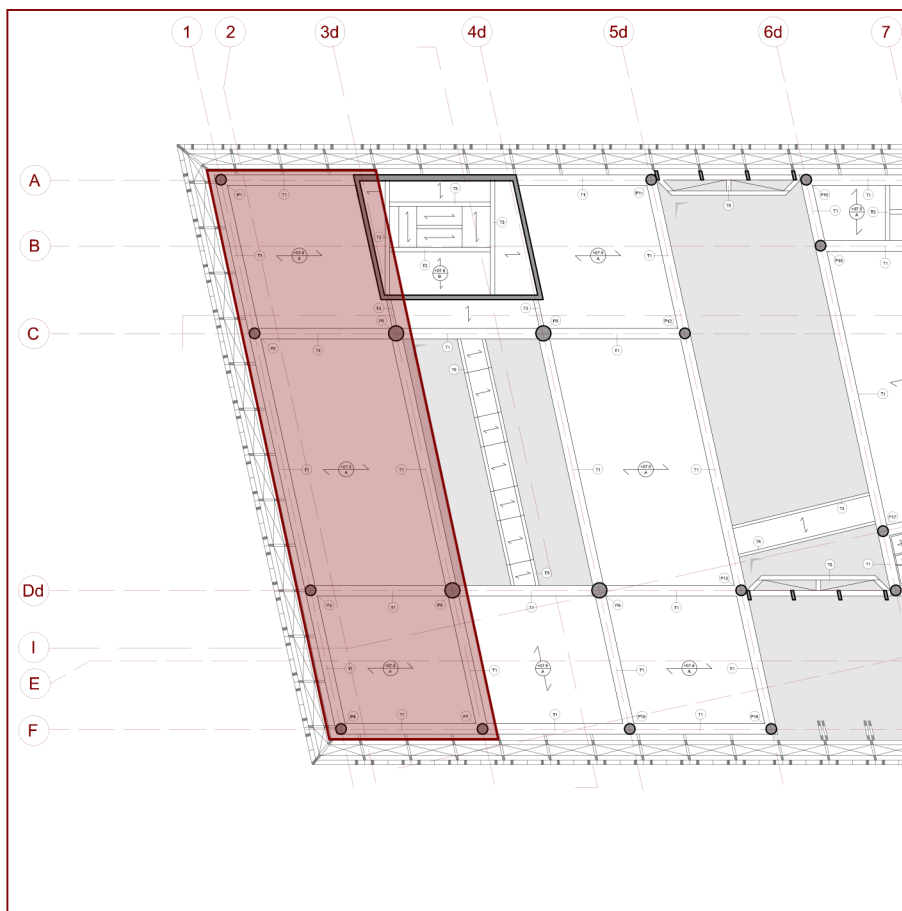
Pianta strutturale posizione dell'area di lavoro - Primo piano.
